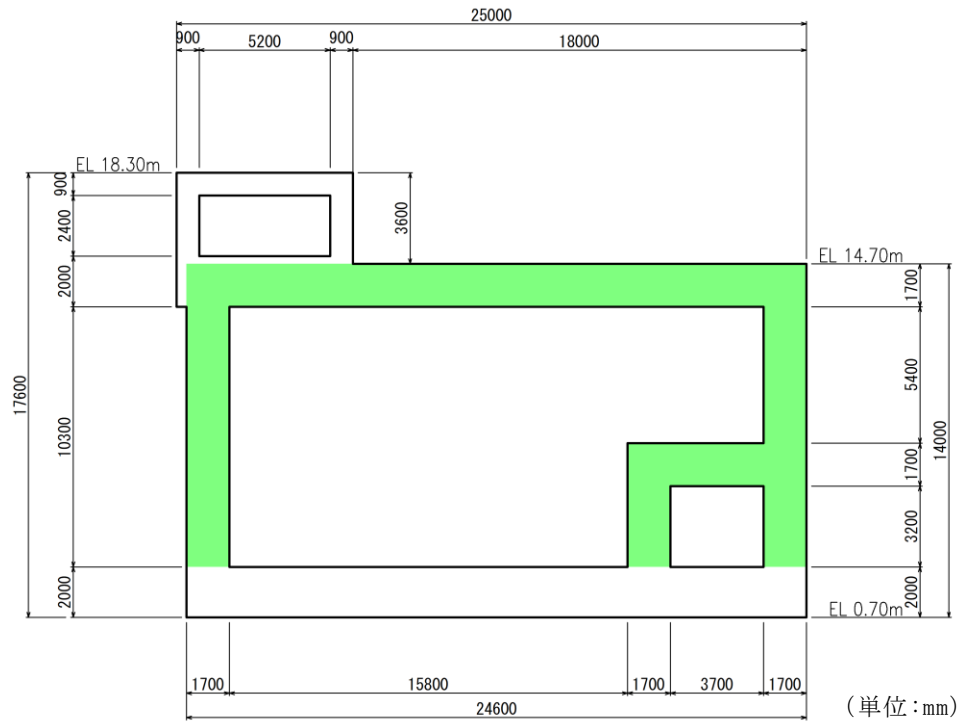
第 1 ベントフィルタ格納槽 断面図 (A-A 断面)
